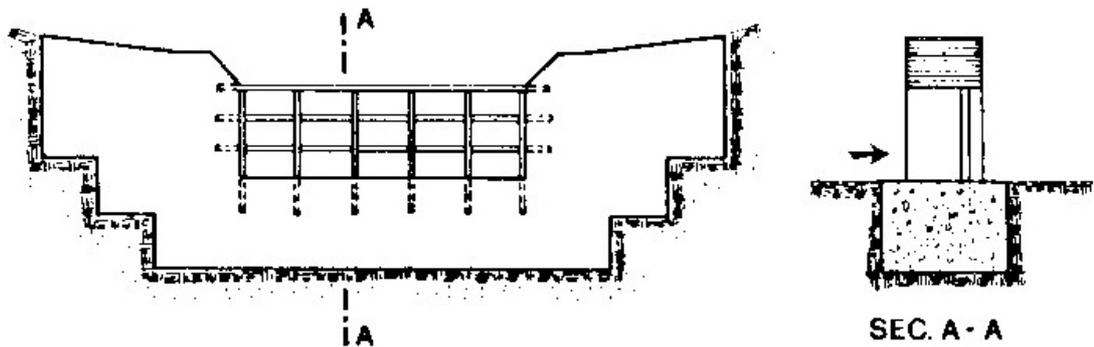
Dique abierto reticular o con rejas (fuente: AIDI-IILA, 1983).
